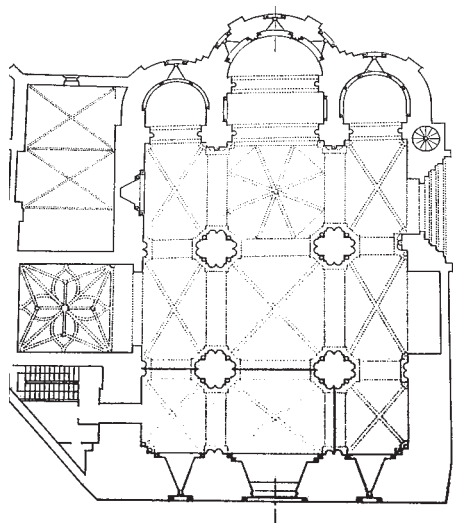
Sangüesa. Iglesia de Santa María. Planta
